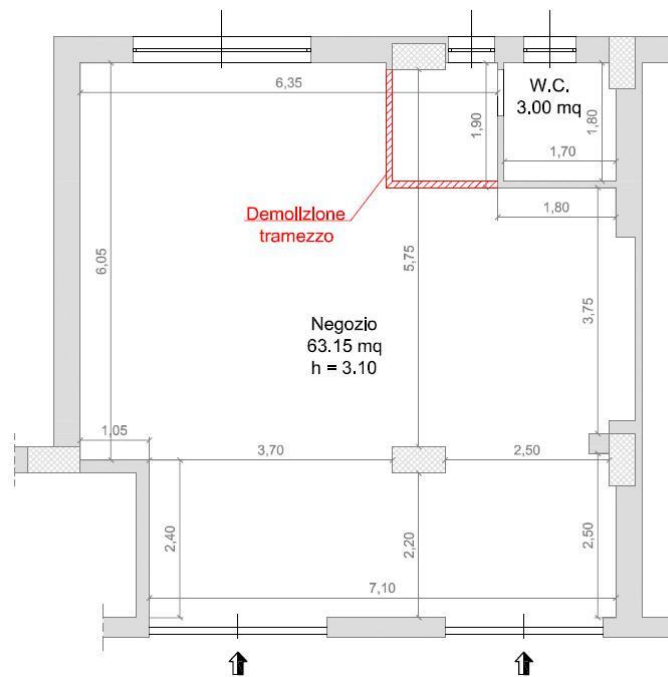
Planimetria Stato di Fatto Foglio 30, p.la 2169, sub 104.
